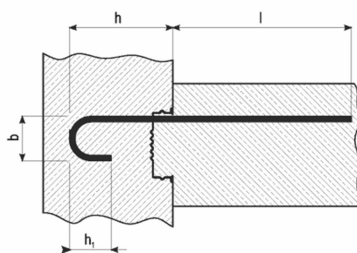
Prętowy element łączący BINDAX do łączenia elementów żelbetowych
